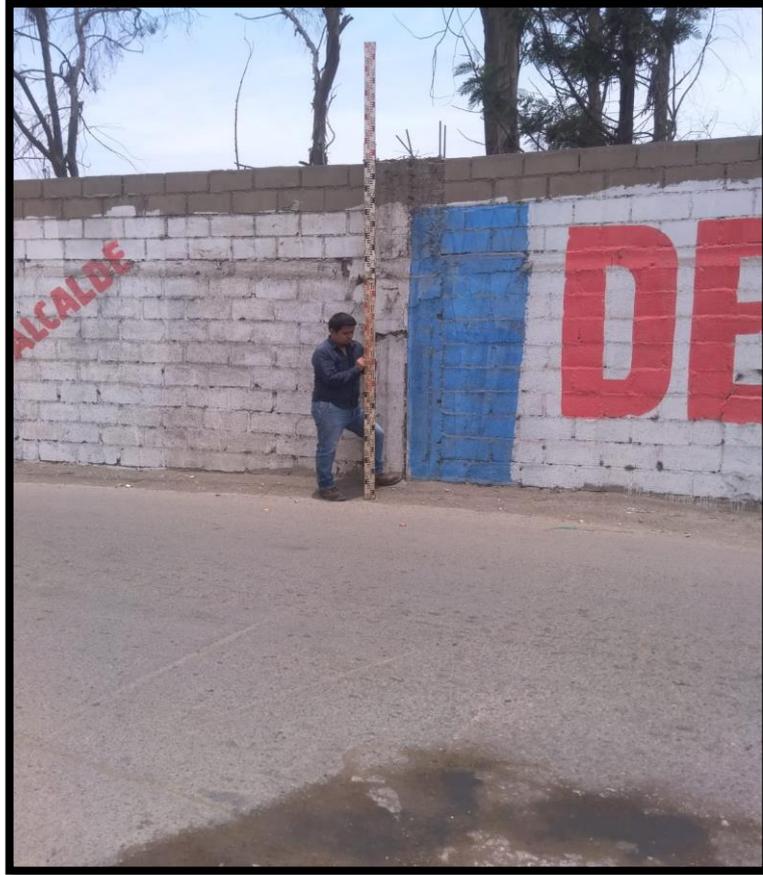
Levantamiento de la pared, pista y vereda Estacion-3
